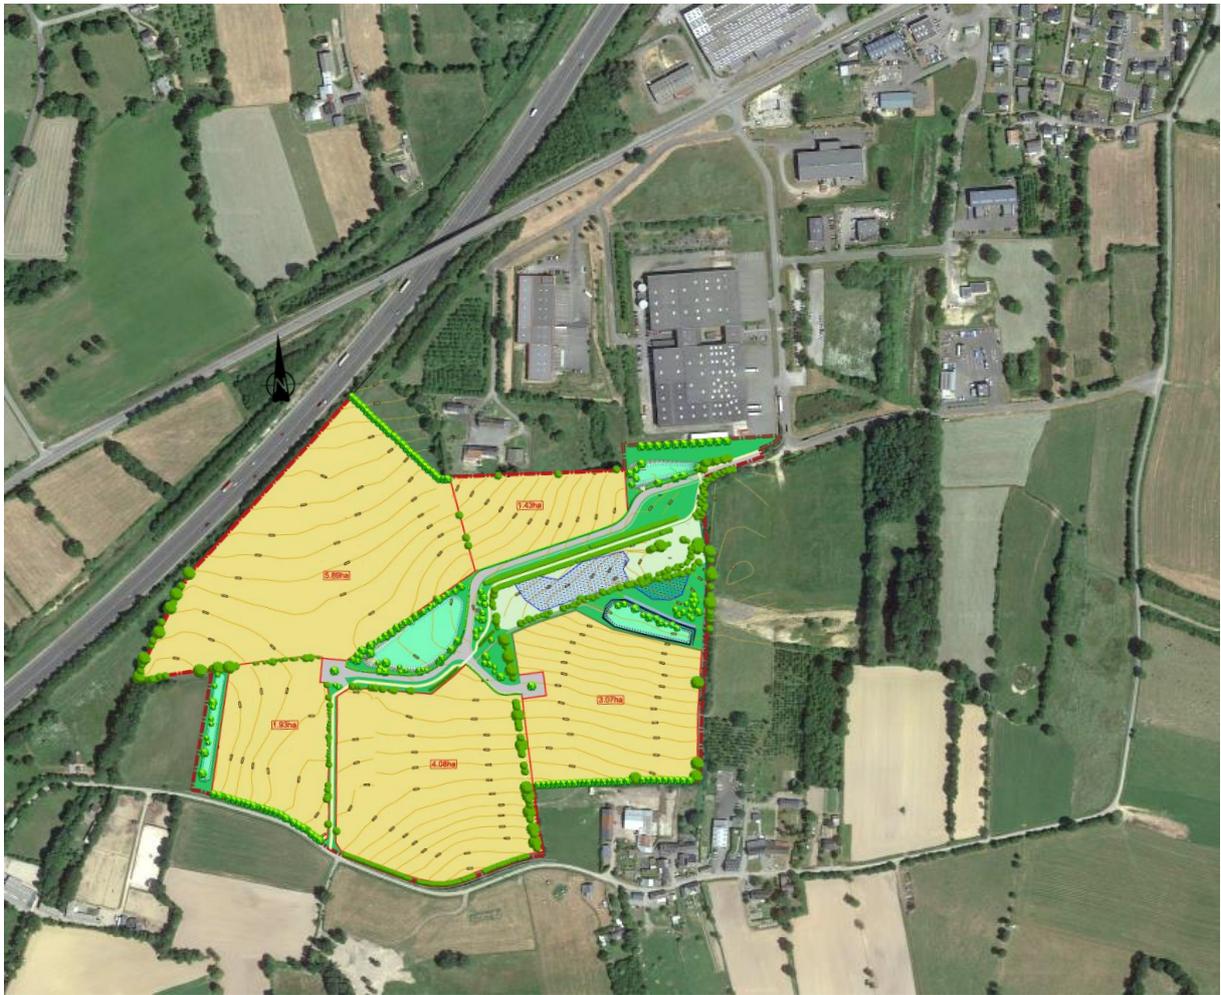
PLAN DE MASSE DU PROJET DANS SON ENVIRONNEMENT
